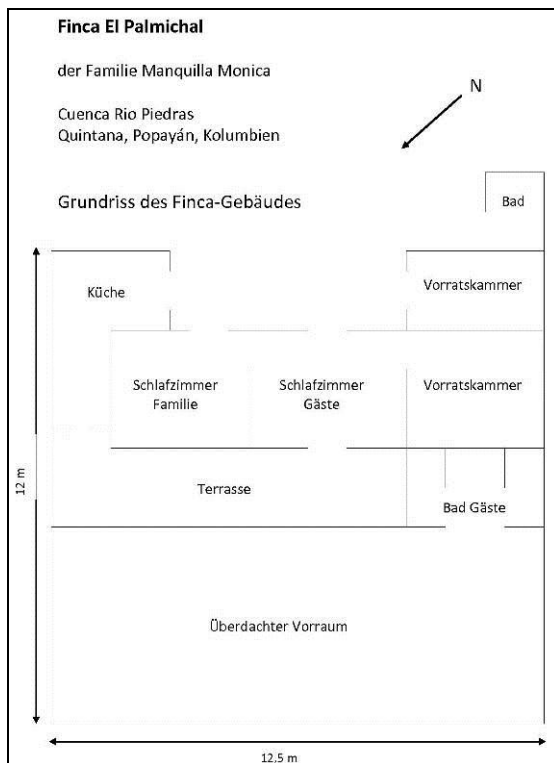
Grundriss des Wohnhauses.
